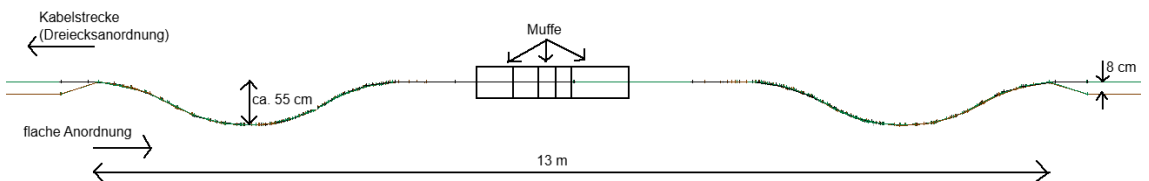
Montageskizze 1800-mm²-Muffe - Seitenansicht
